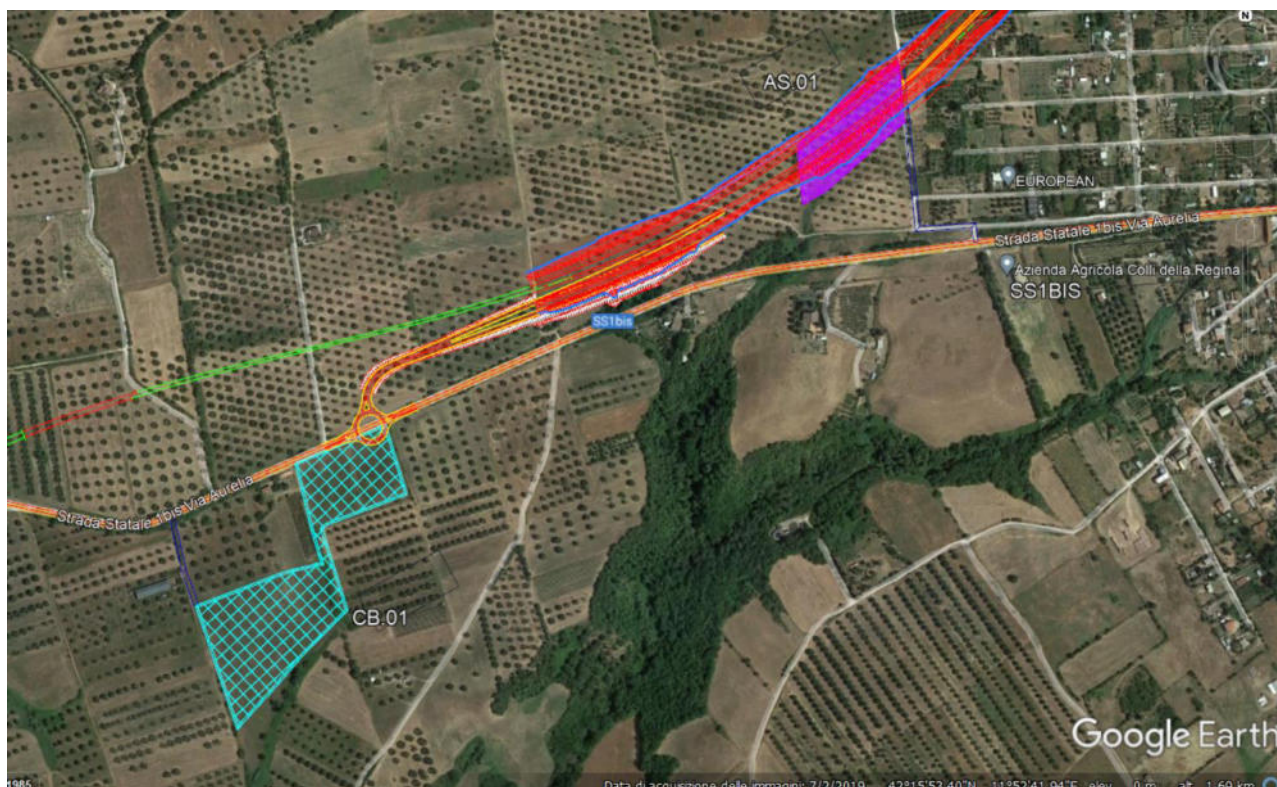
Aree di cantiere: cantiere Base CB.01, area di stoccaggio AS.01
